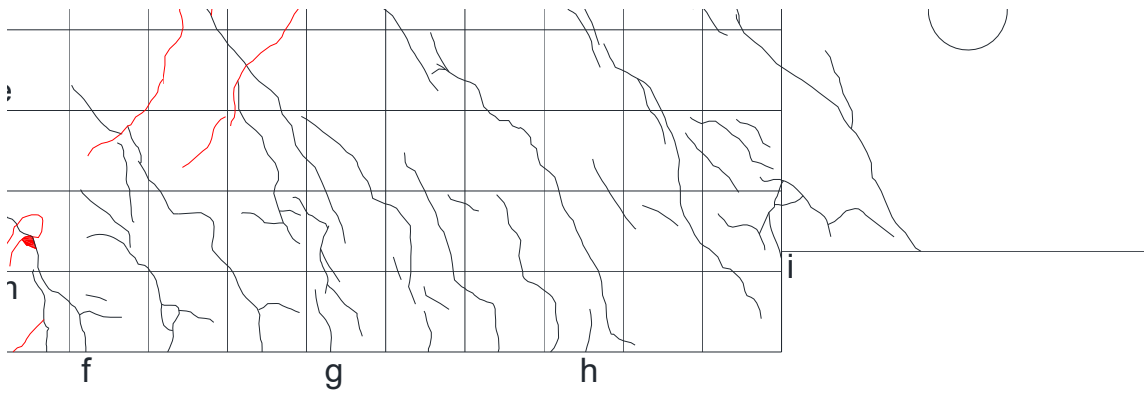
基礎梁ひび割れ測定位置 (試験体 E-2 正載荷)
